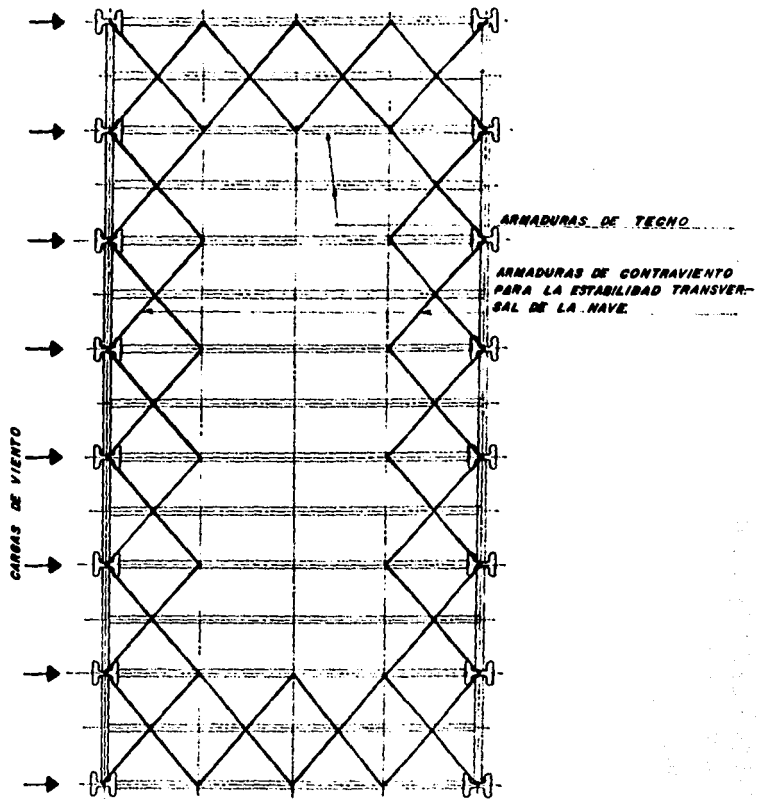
Disposición de las armaduras longitudinales de contraviento en la cuerda inferior, para la estabilidad transversal de la estructura.
